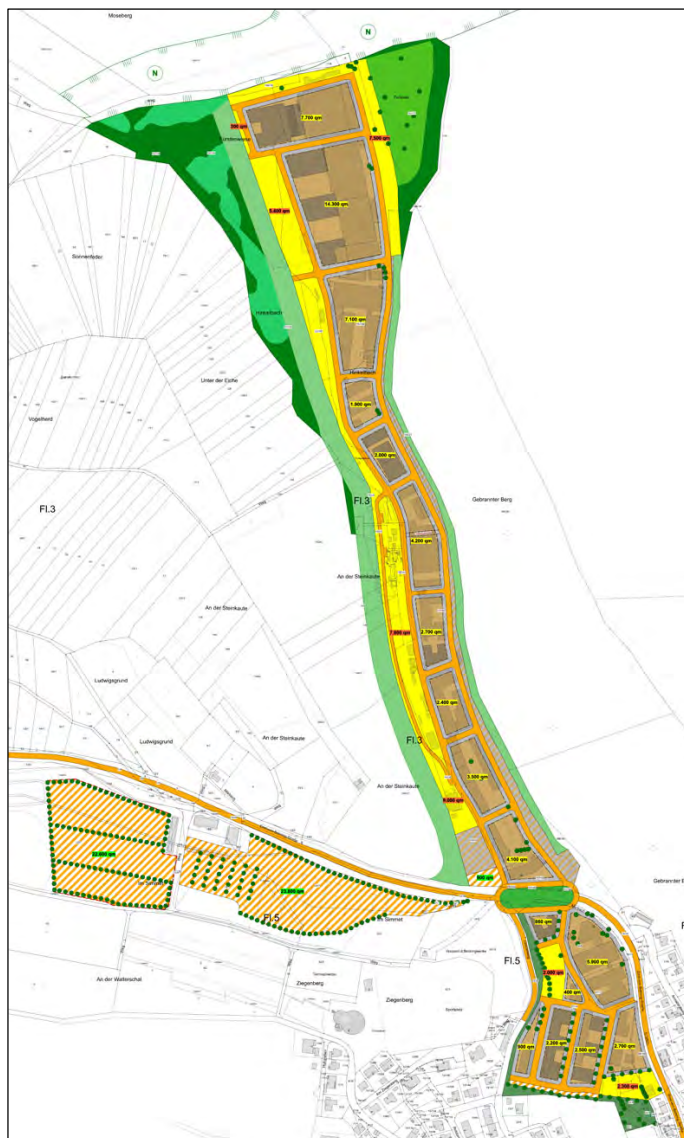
Site-Master-Plan, Teilbereich: Hauptwerk, Stand: Okt. 2006
